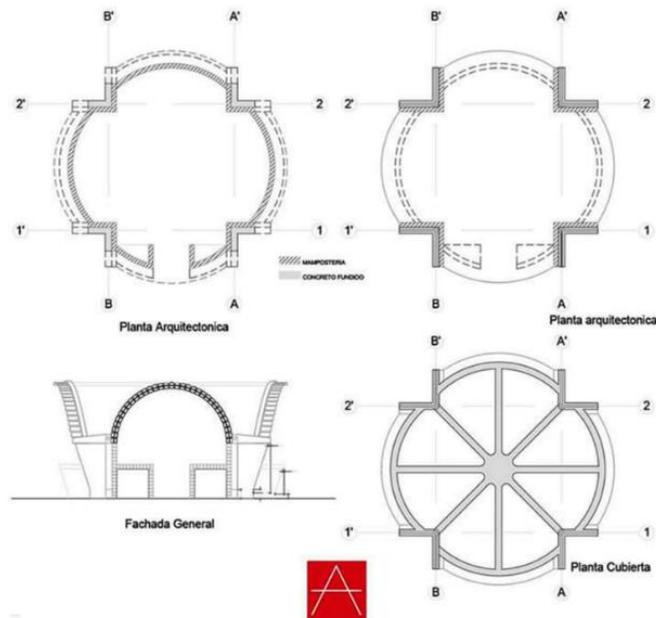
Planimetría Loma de la Cruz. Repositorio Fotográfico SCA.
